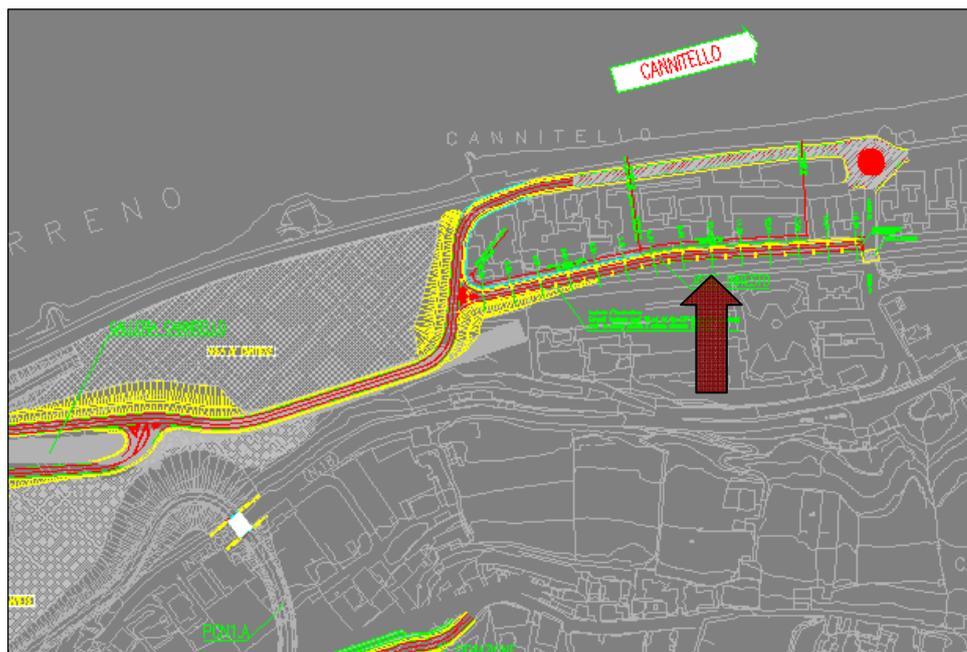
Planimetria di progetto "Asse Innesto"
